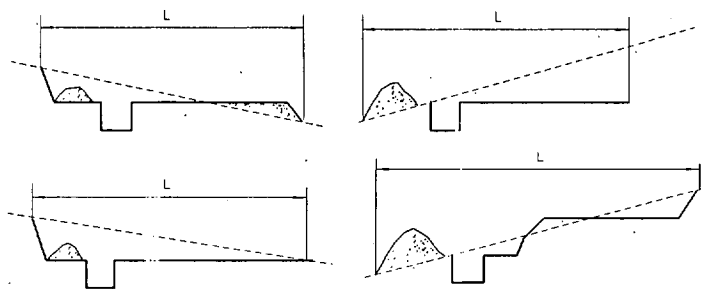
Terreno a ocupar para la pista provisional de construcción.
